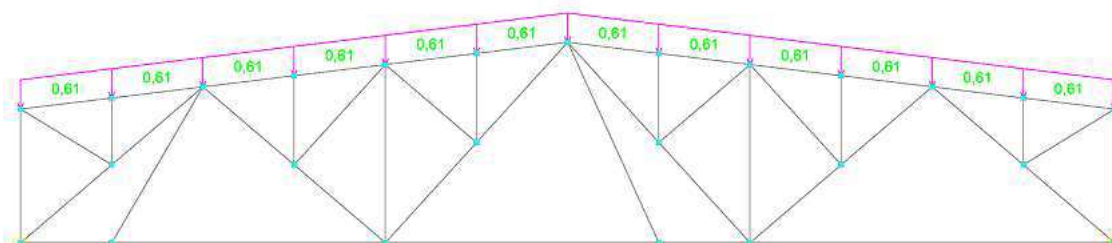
Схема загрузки фермы снеговой нагрузки
